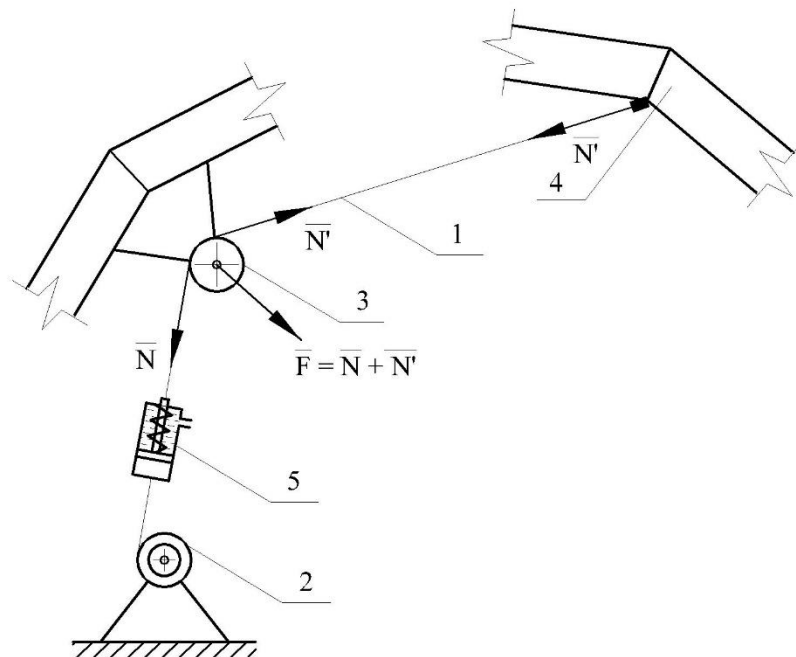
Установка гасителя с промежуточной точкой крепления
